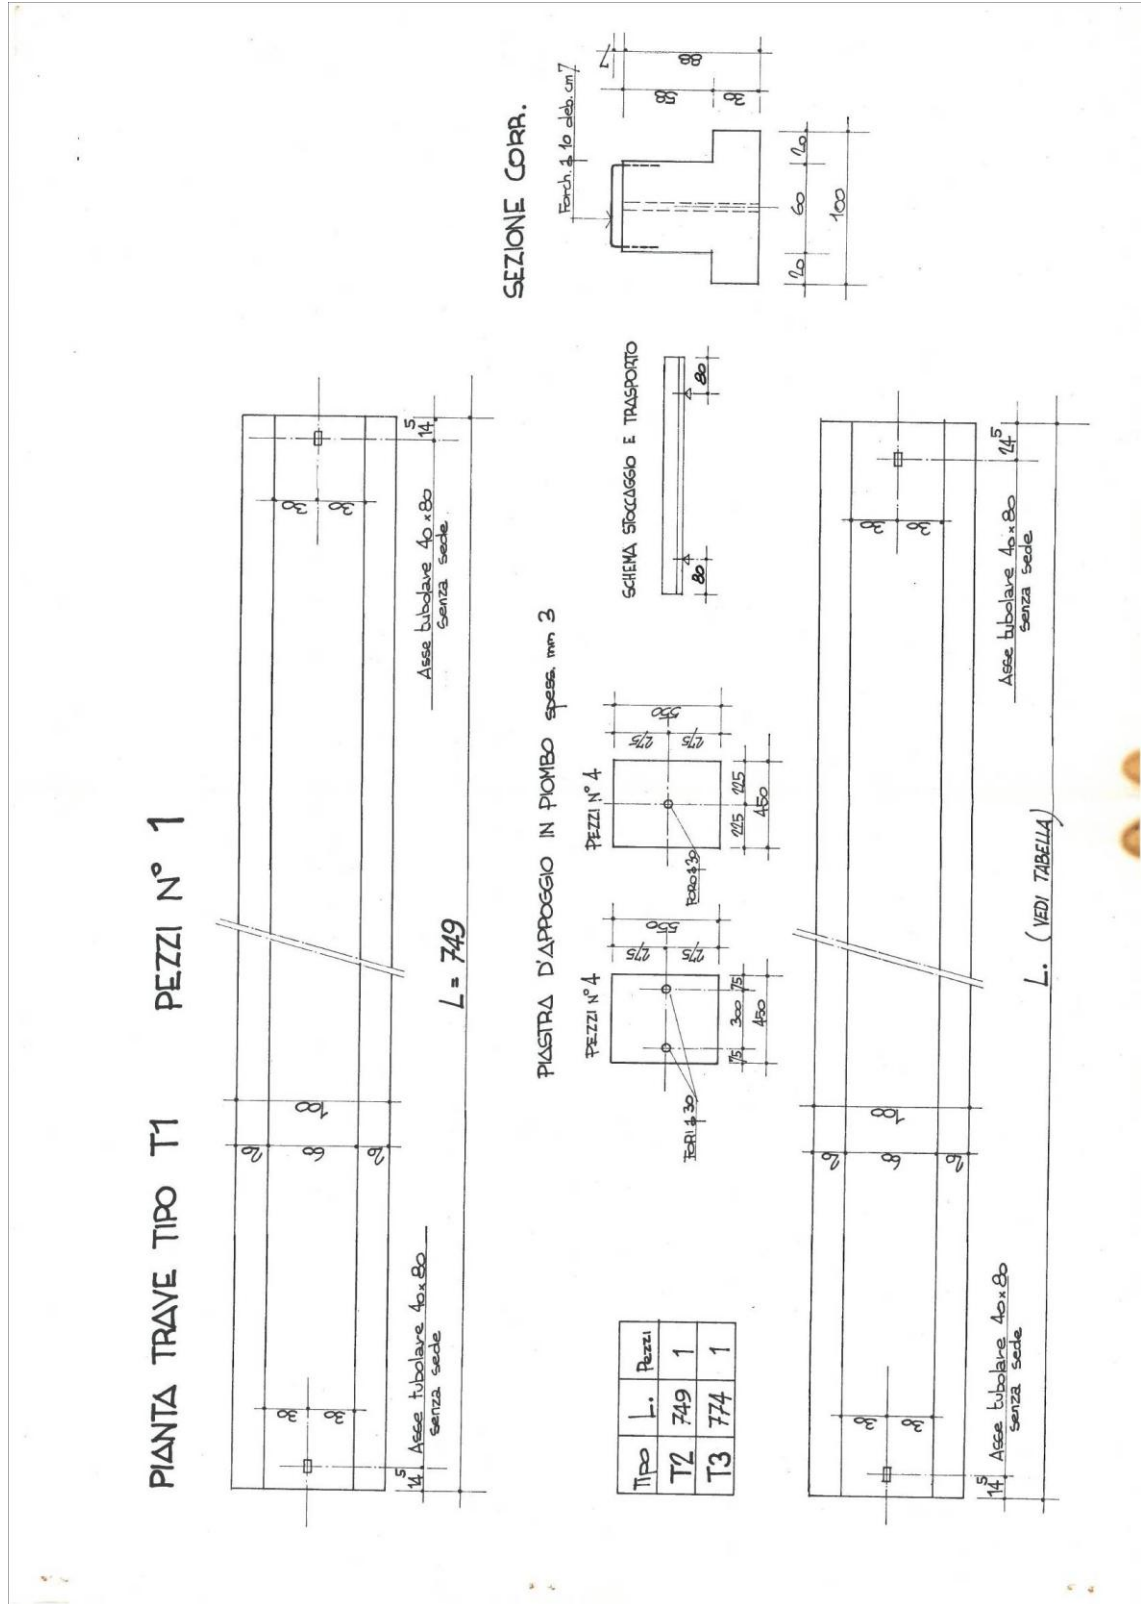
Particolare di A.1990.cap.us.T14 - Armatura e abaco trave tipo T1 T2 T3 - Pianta, prospetti e appoggi
